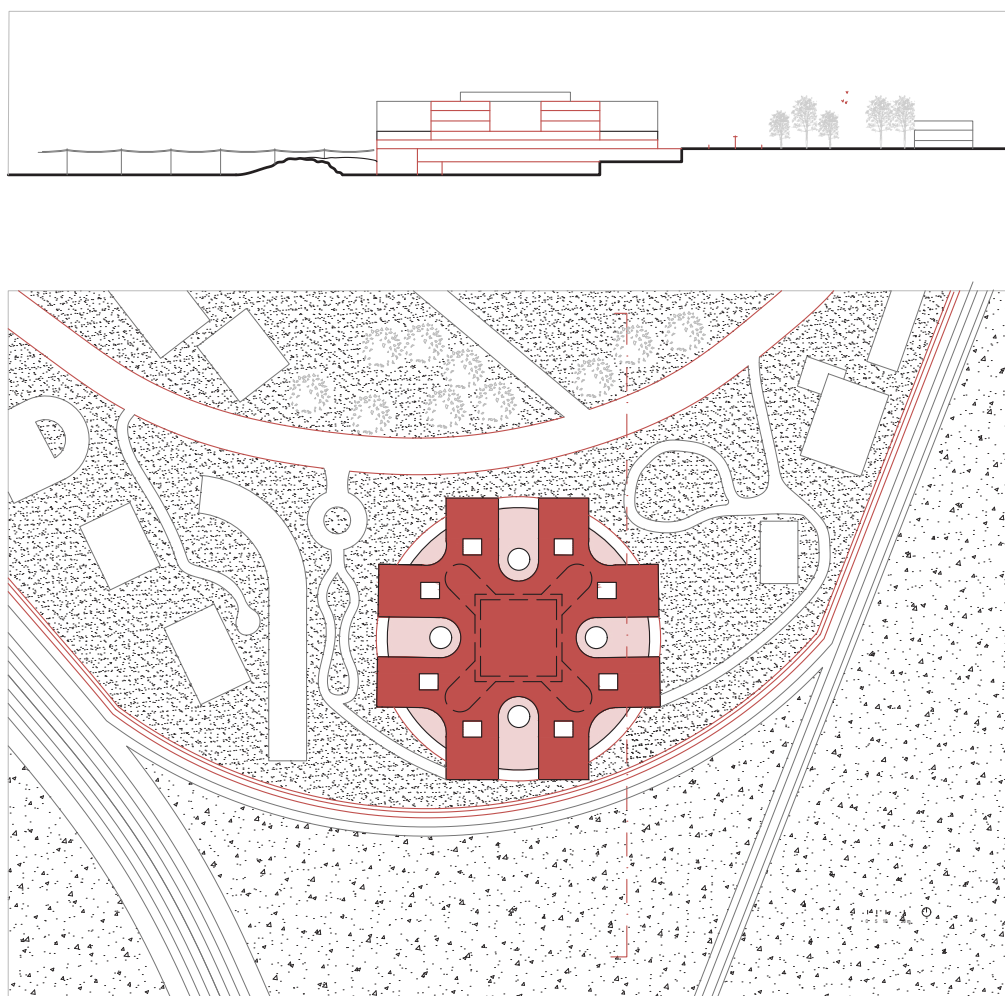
Coupe et plan d'implantation de l'hôpital CHIREC Delta en 2017
